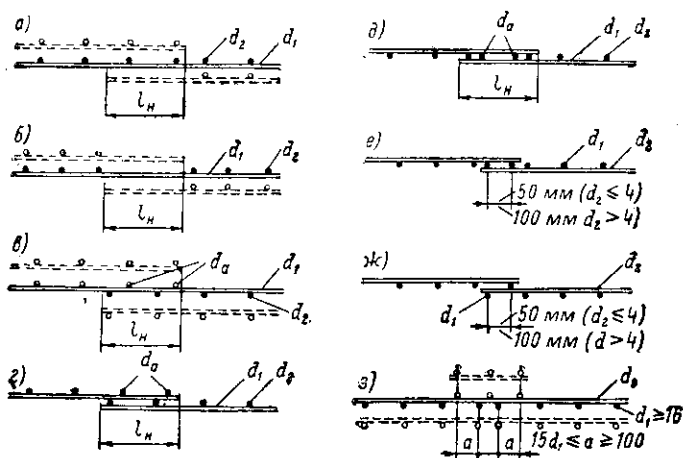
Стыки сварных сеток внахлестку без сварки
